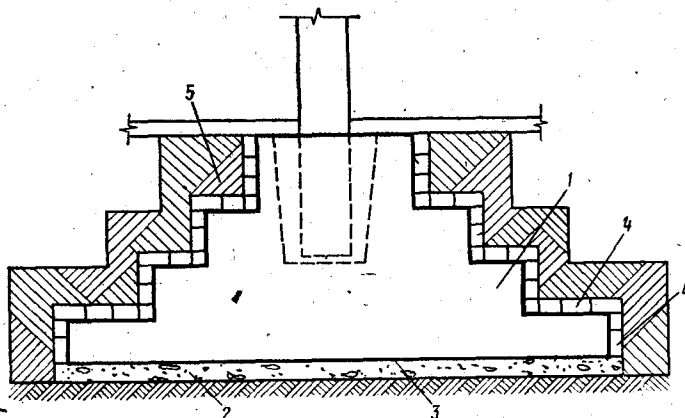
Защита фундамента при агрессивных грунтовых водах:
